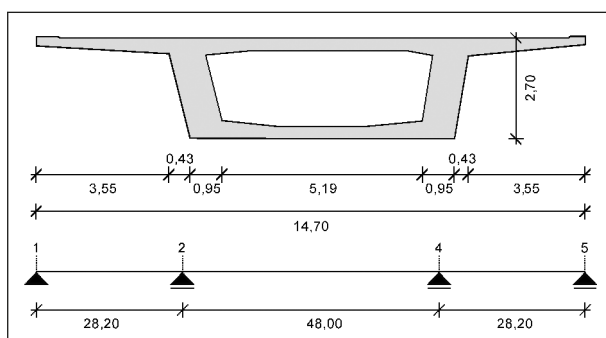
1-zelliger Hohlkastenquerschnitt im Bemessungs-schnitt und statisches System in Längsrichtung für Brücke 4
